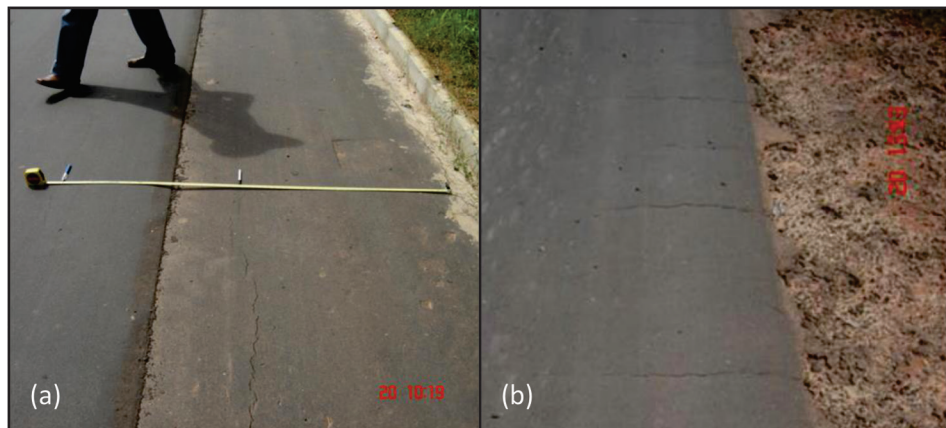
Trincas na estrutura de pavimento: (a) longitudinais; (b) transversais (Camapum de Carvalho e Gitirana (2006))
